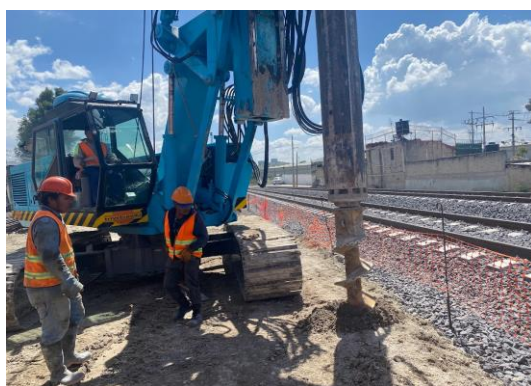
y 92 Autoría Propia (2023) "Vista de trabajos de perforación e izaje de acero para pilas secantes"
